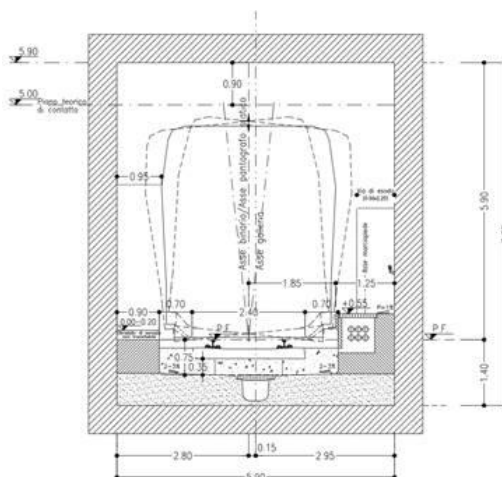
Sezione di intradosso scatolare della galleria Olimpia
